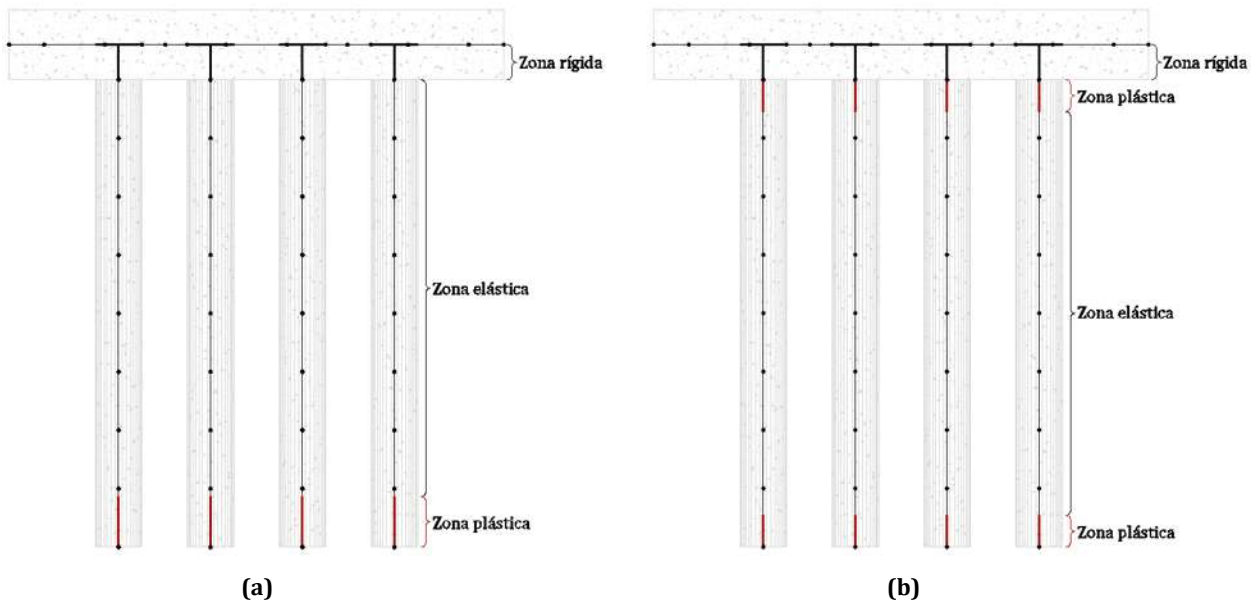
Modelo de zona plástica para pilas, en dirección: (a) longitudinal, y (b) transversal
